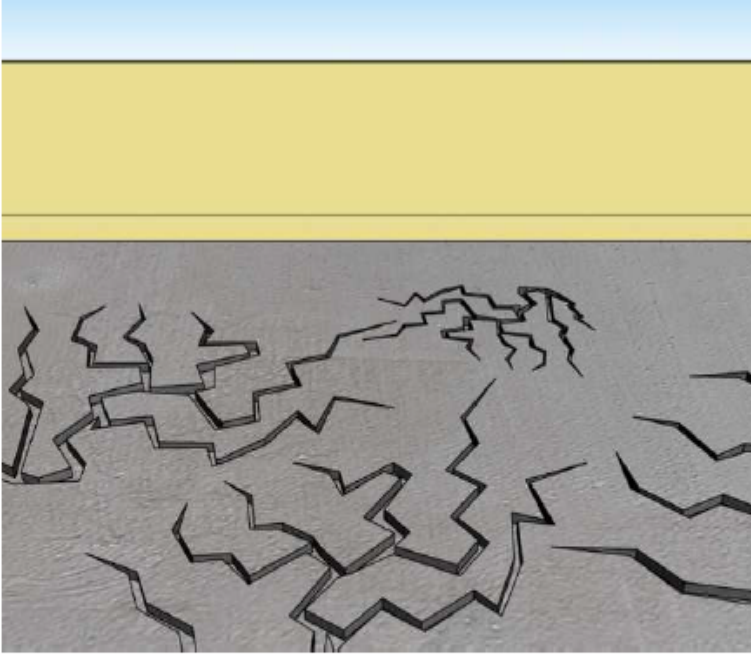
Sıkıştırma işleminde sonra çevresel etkiler nedeniyle rötre çatlakları oluşur. betonun hala plastik kıvamda ise yeniden vibrasyon uygulaması yapılması faydalıdır. Ayrıca kolonlarda üst üst 50-60 cm'lik tabaka yeniden vibrasyona tabi tutulabilir. Bu bölge üzerinde yeterli ağırlık olmadığından sıkışması daha zordur.
